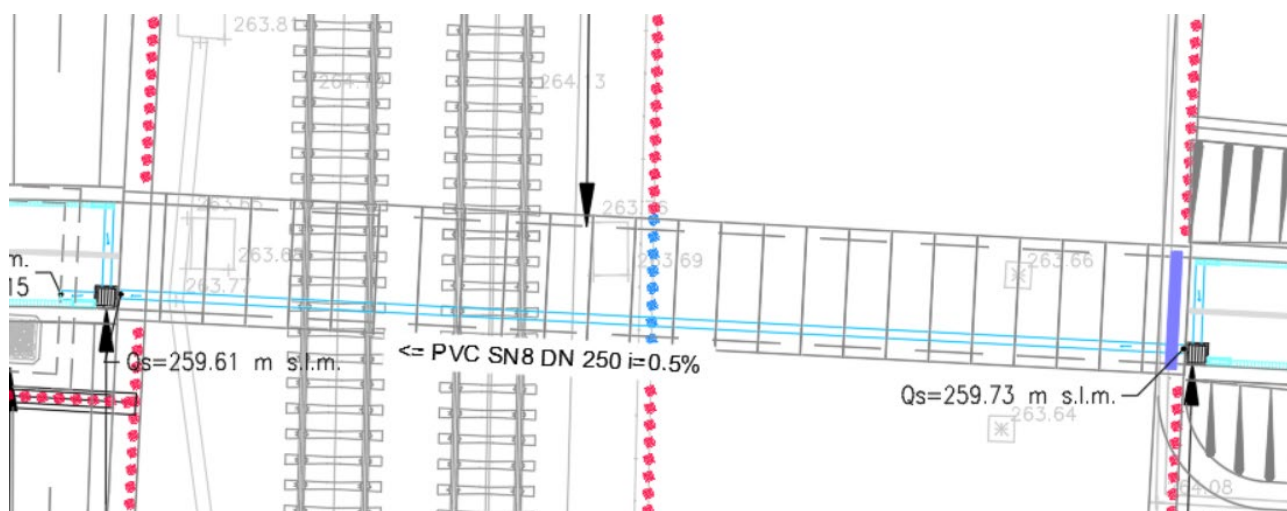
Stralcio planimetrico condotta di collegamento della pista lato est con la vasca di laminazione
